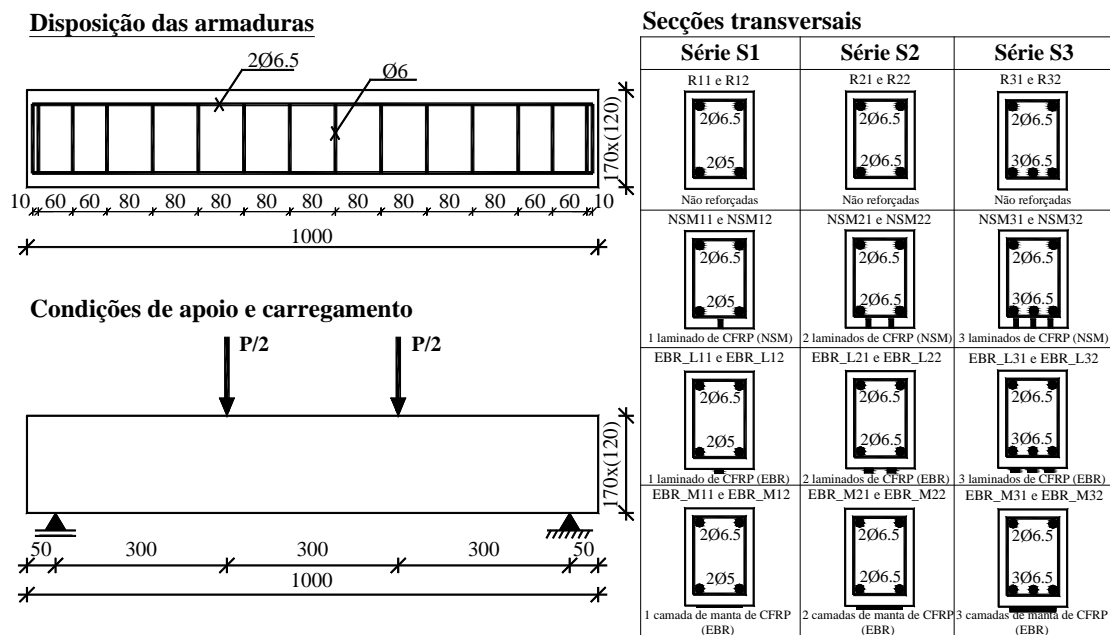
Geometria, armaduras e reforço das vigas (Fortes e Barros, 2002).
